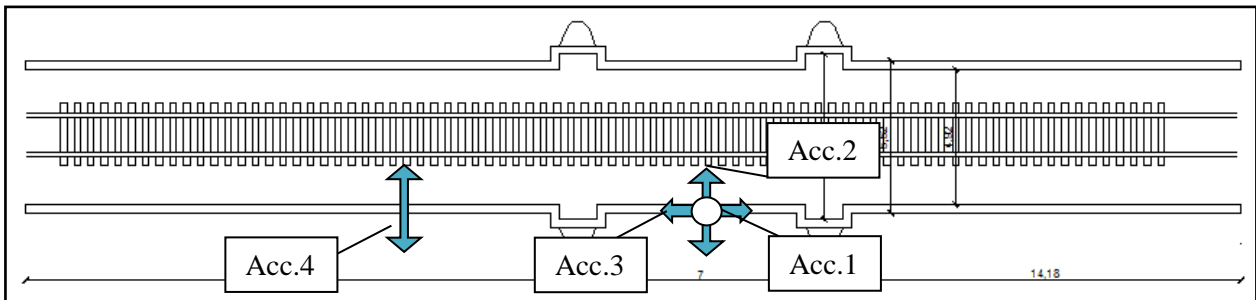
Disposizione degli accelerometri (vista planimetrica).
